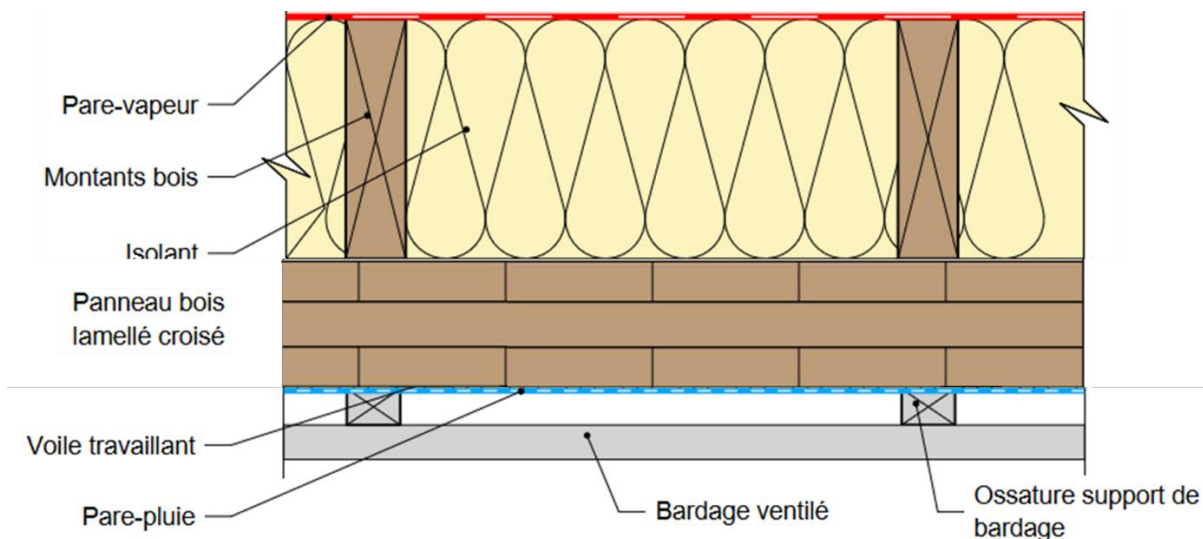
Paroi CLT isolée par l'intérieur avec système pare-pluie ou de protection à l'eau souple sur support continu (coupe horizontale)
